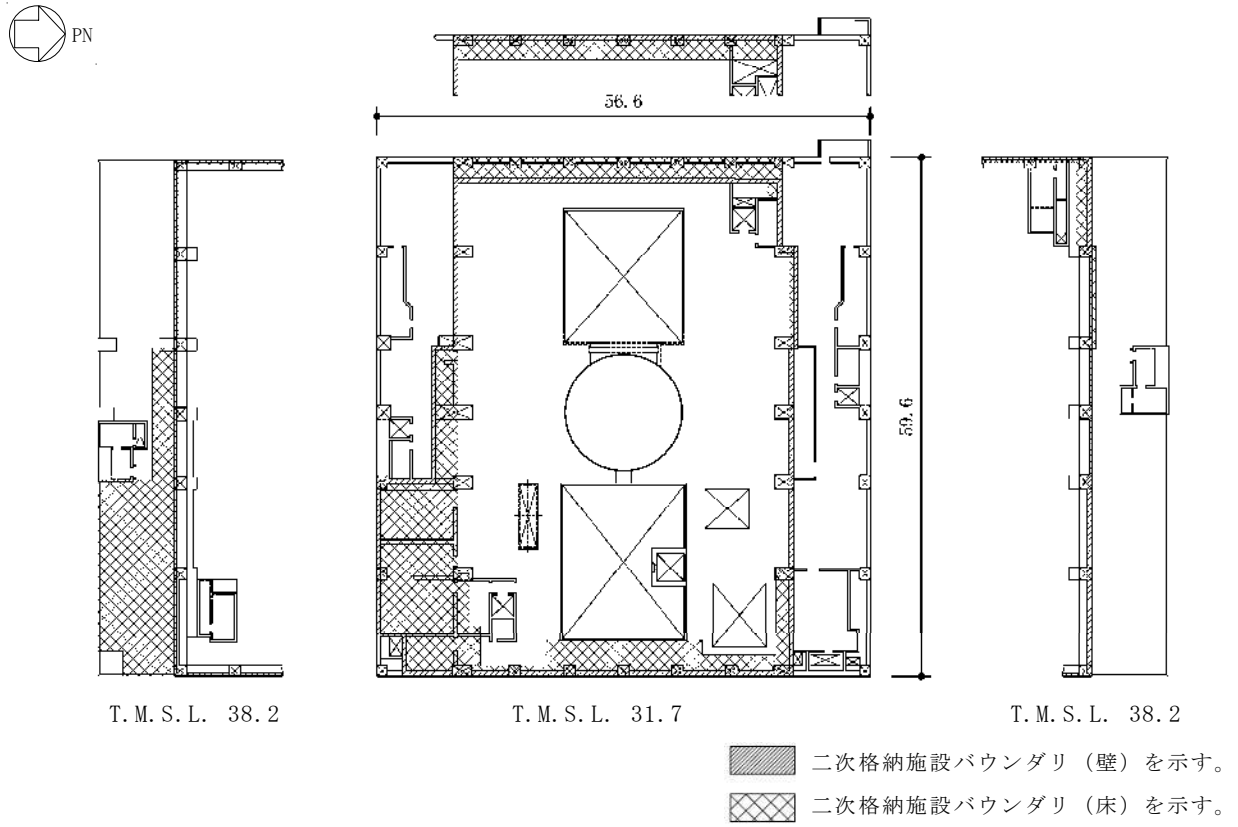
原子炉建屋原子炉区域（二次格納施設）の範囲の平面図（単位：m）
